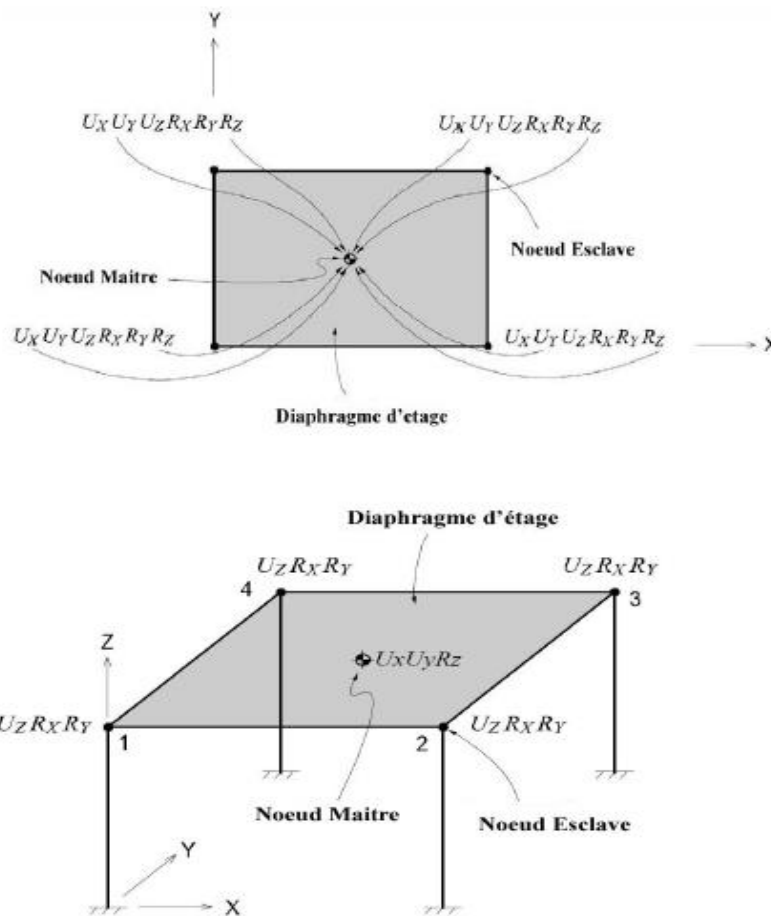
Les déformations dans le plan du plancher    Figure 3.9: Rotation du plancher
